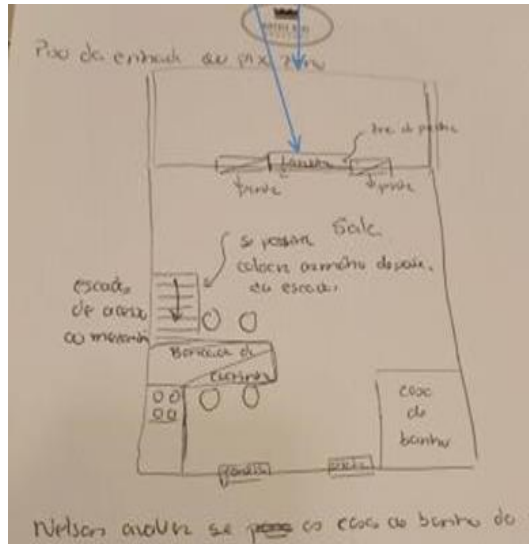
Planta de Alterações do Piso -1. Fonte:
